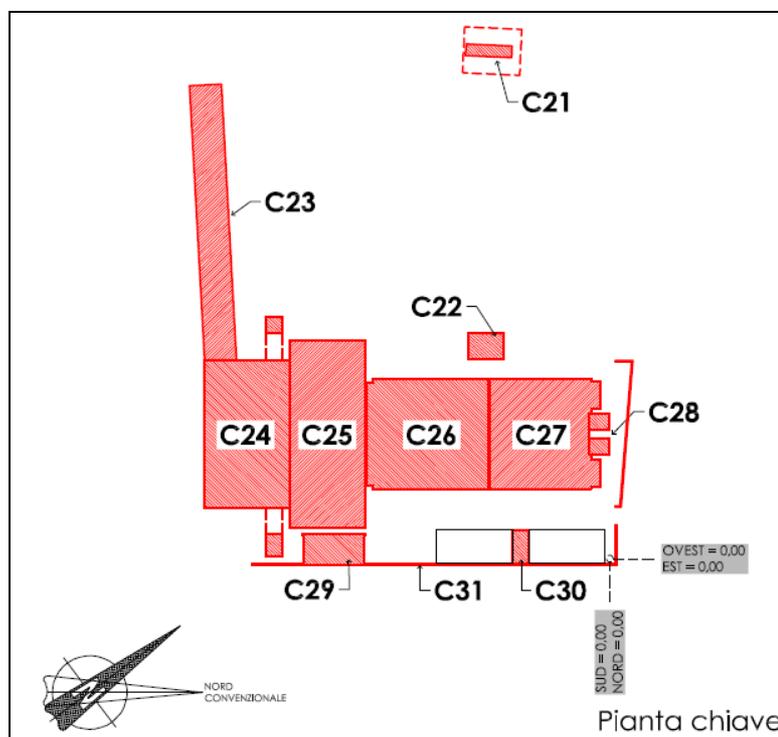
Pianta dell'impianto di termovalorizzazione con indicazione dei fabbricati
